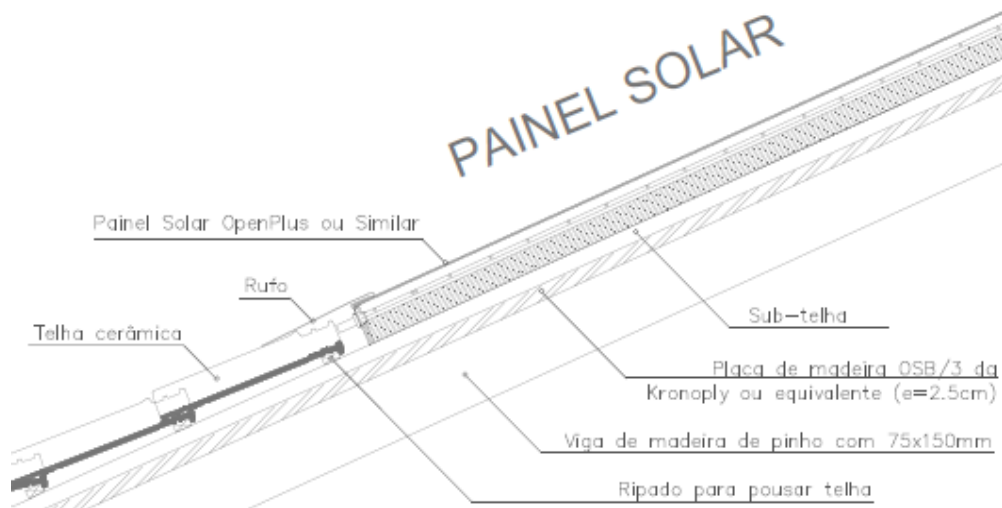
Pormenor do painel solar na cobertura [17]
